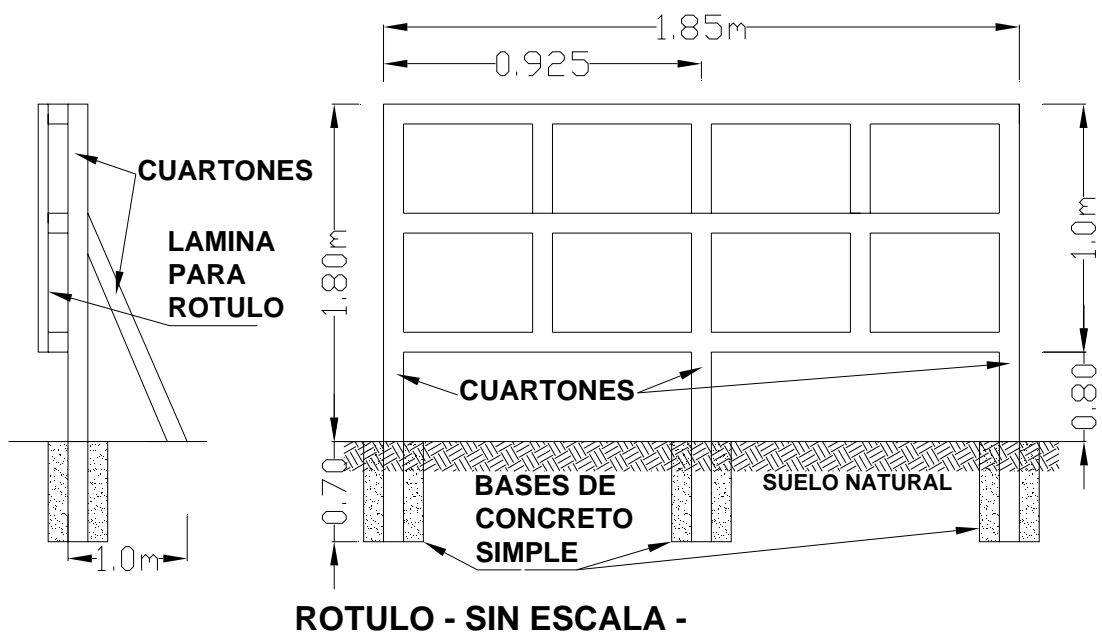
Detalles de la estructura de madera para el rótulo de identificación del proyecto.
